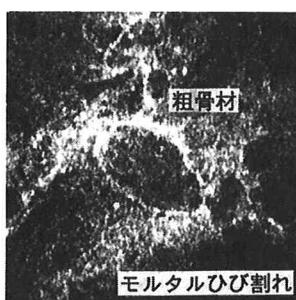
モルタルひび割れ(4倍) 写真-2 気泡ひび割れ(4倍)
